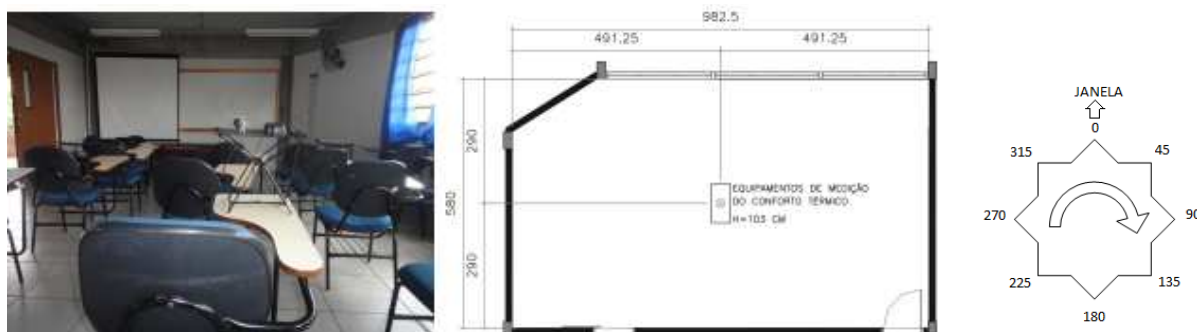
Disposição dos equipamentos (foto e planta baixa); e orientação para medição da ventilação do ar
